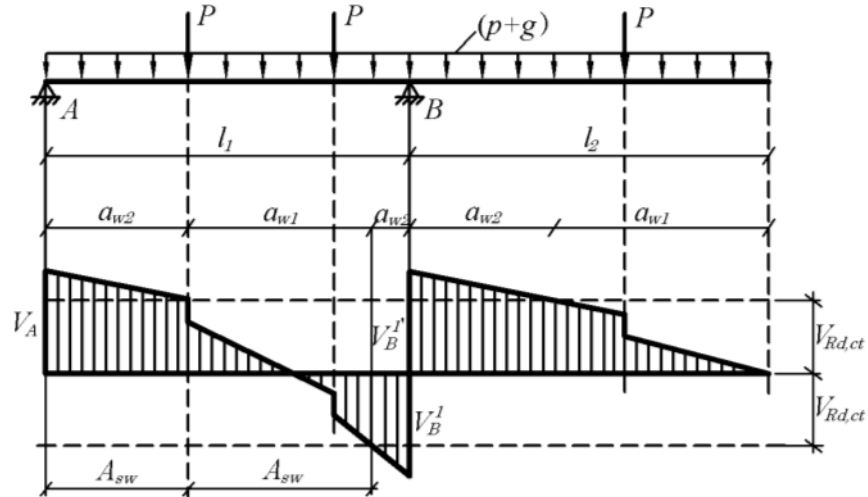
Разбиение балки на участки для расчета поперечного армирования
